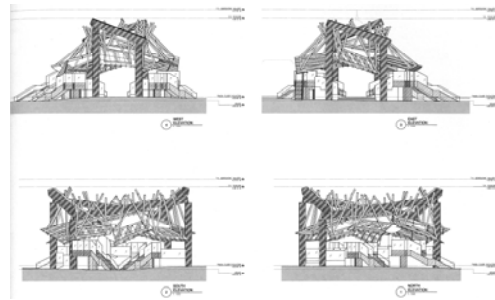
Alçados, pavilhão de Frank O. Gehry, 2008.
